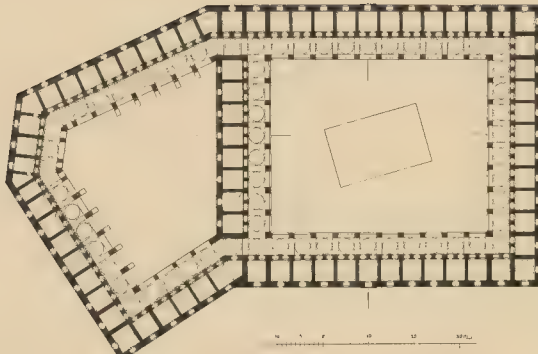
Kürkdschiler Han. Grundriß des Obergeschosses.
